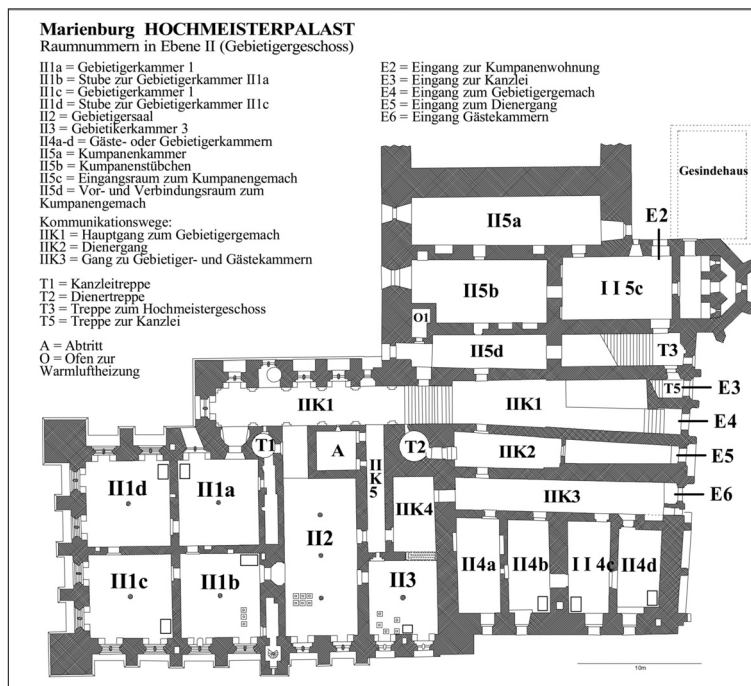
Grundriss von Ebene II (Gebietigeschoss) mit Angabe der Raumnutzung
